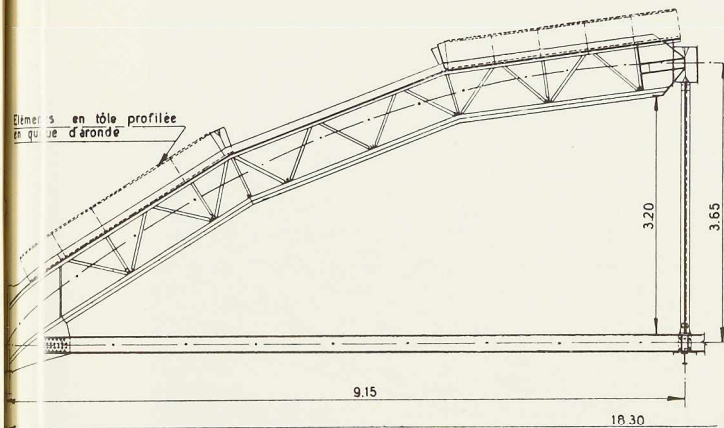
Demi-coupe verticale dans une ferme supportant la toiture.
